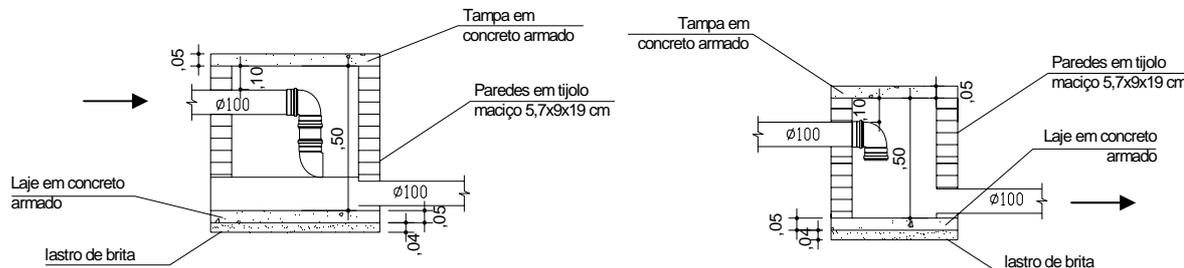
Corte BB e corte CC das caixas de passagem de entrada e saída do efluente, respectivamente. *Dimensões em metros (m).
